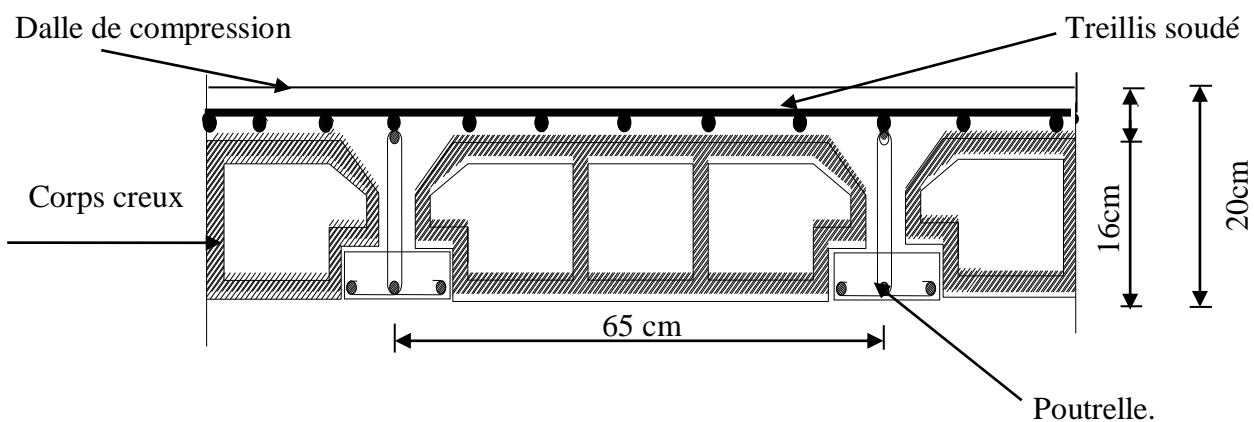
coupe verticale d'un plancher en corps creux
